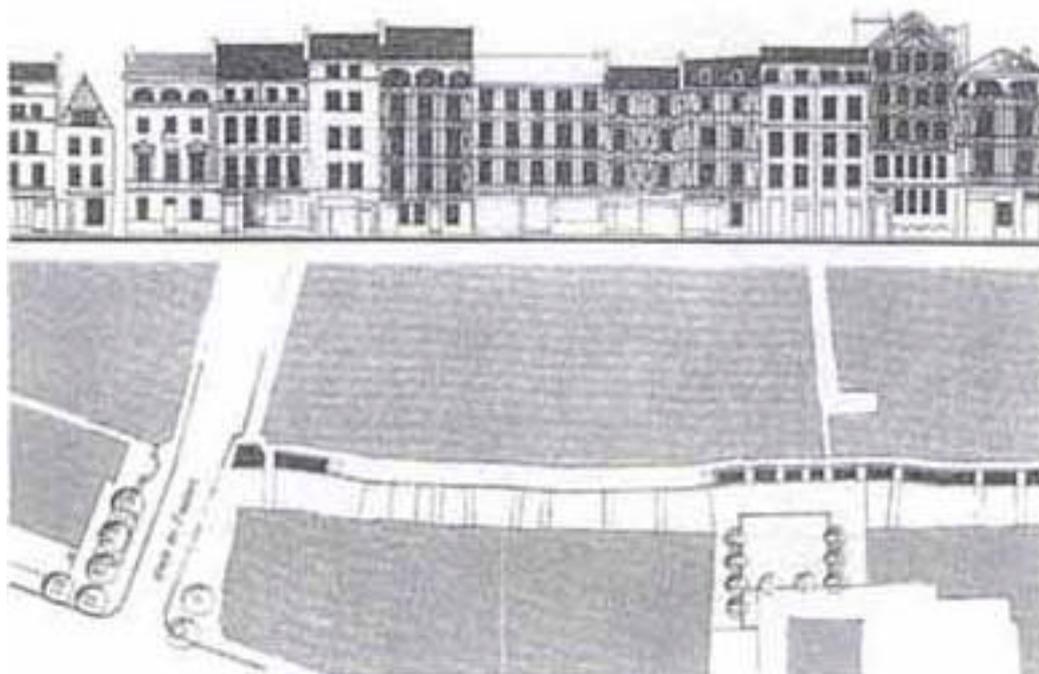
Planimetria e geometria degli edifici di Rue Eau de Robec a Rouen.
